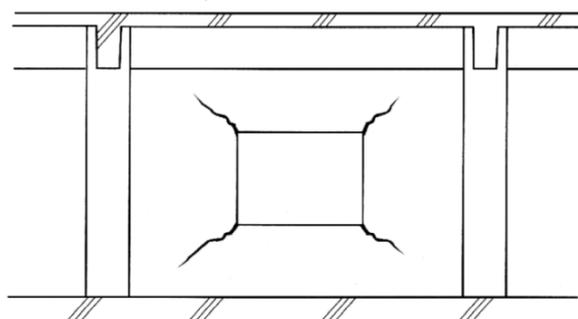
乾燥収縮ひび割れの典型的な発生パターン
